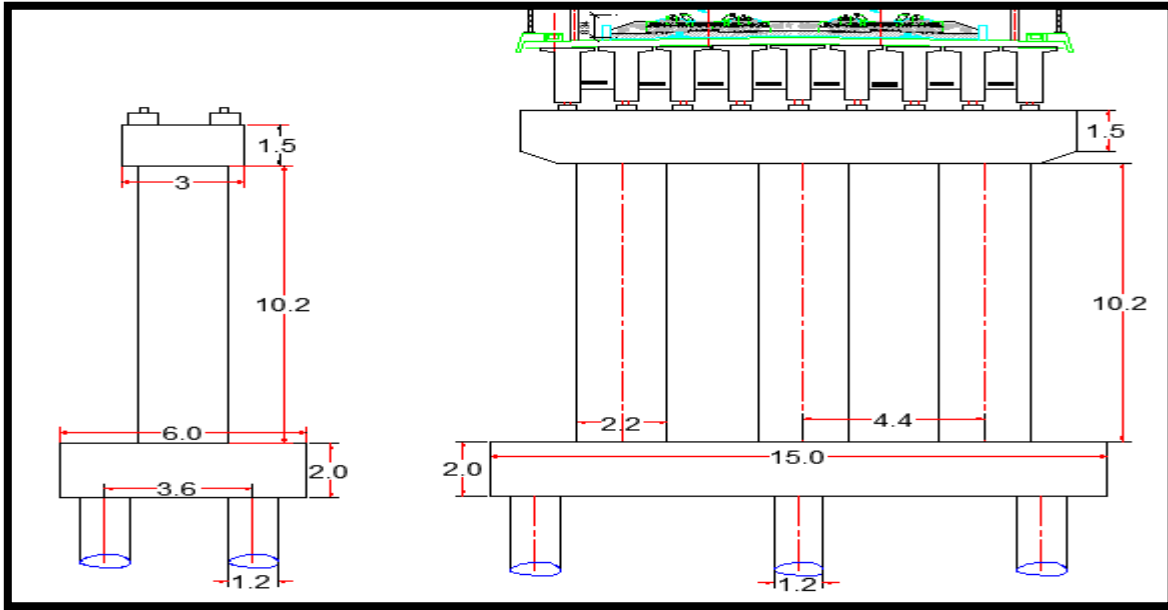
Coupe longitudinale et transversale de la pile.
